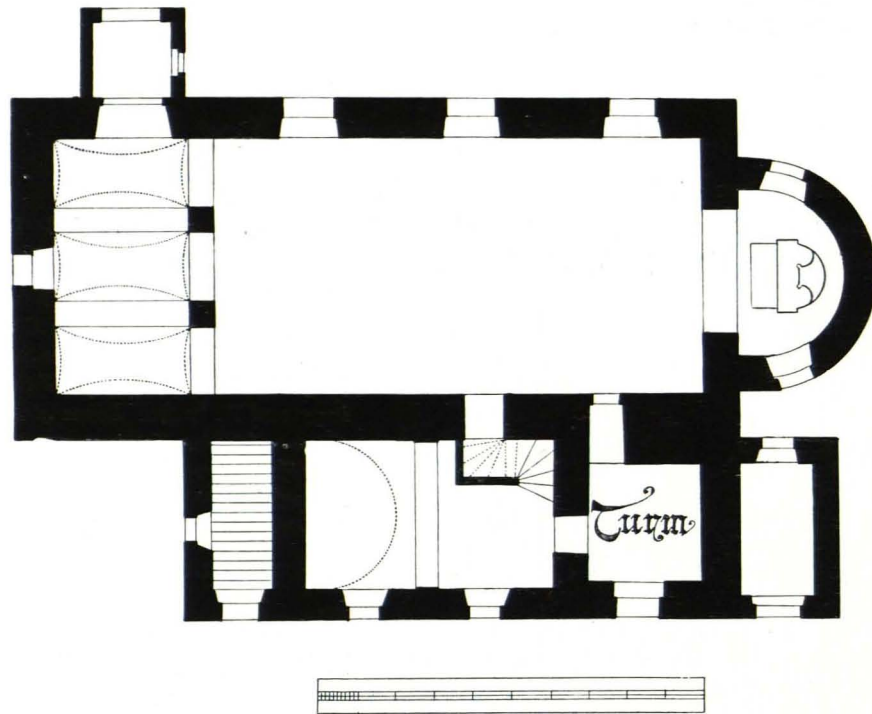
Kirchschlag, Pfarrkirche, Grundriß 1 : 200 (S. 50)
